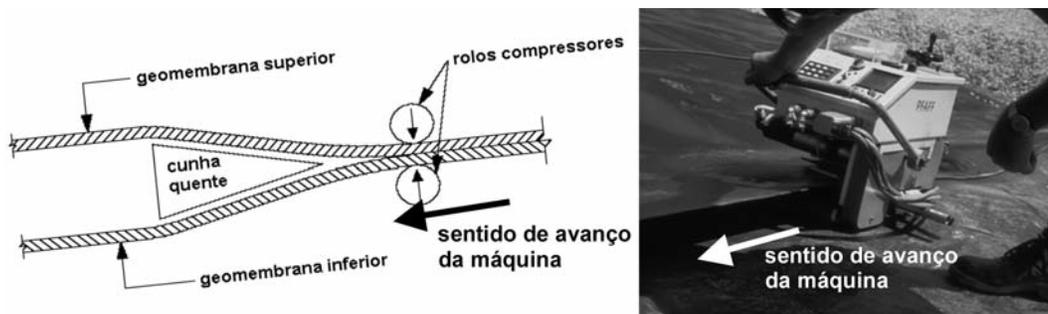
Soldadura por termofusão (Steel Dragon Enterprise CO).
